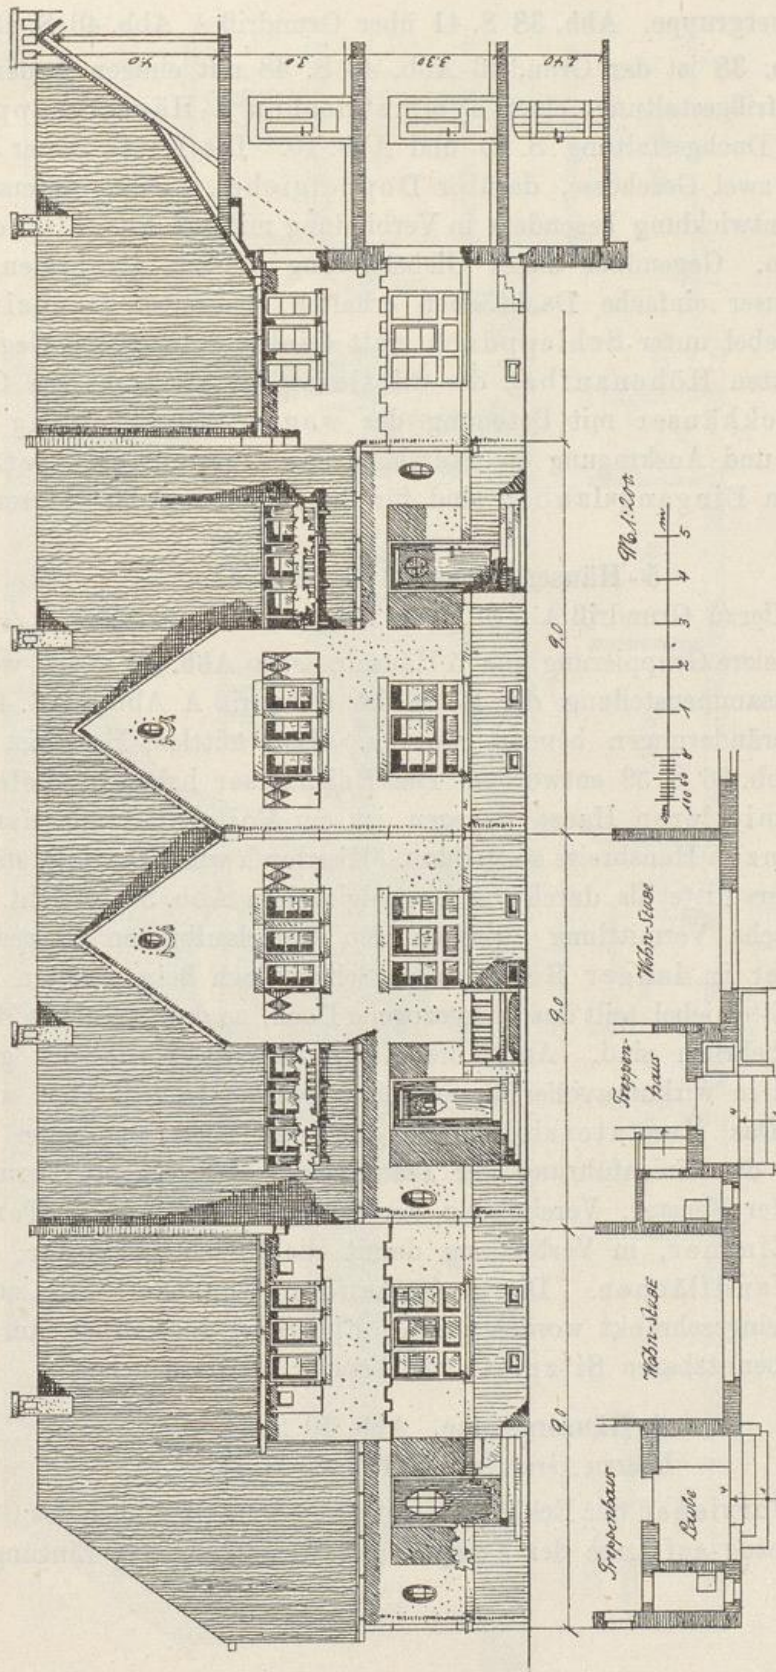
Vierhäusergruppe mit Betonung der Mitte durch höhergeführte Doppelgiebel, Eckhäuser mit wagerechten Höhenteilungen.
